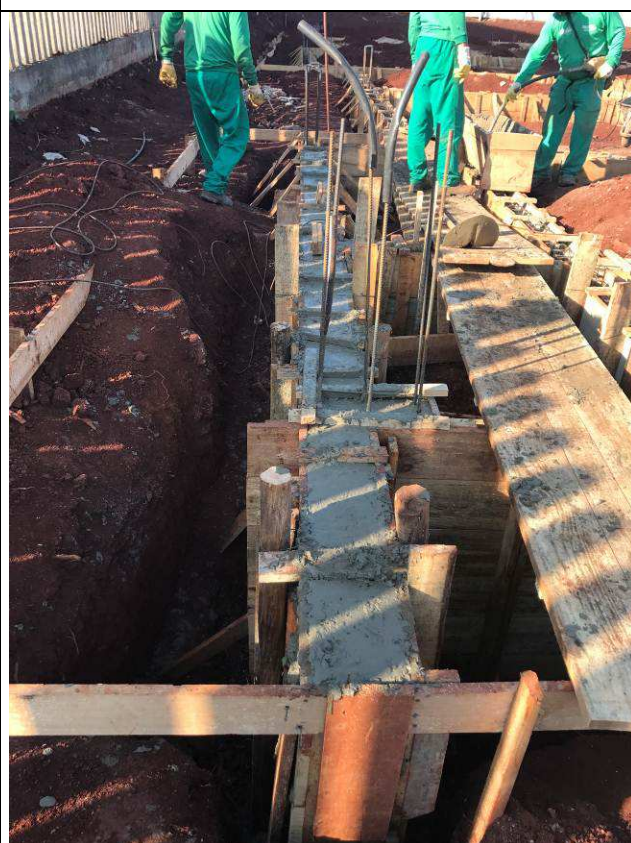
C: Concretagem das vigas baldrames do prédio principal.
